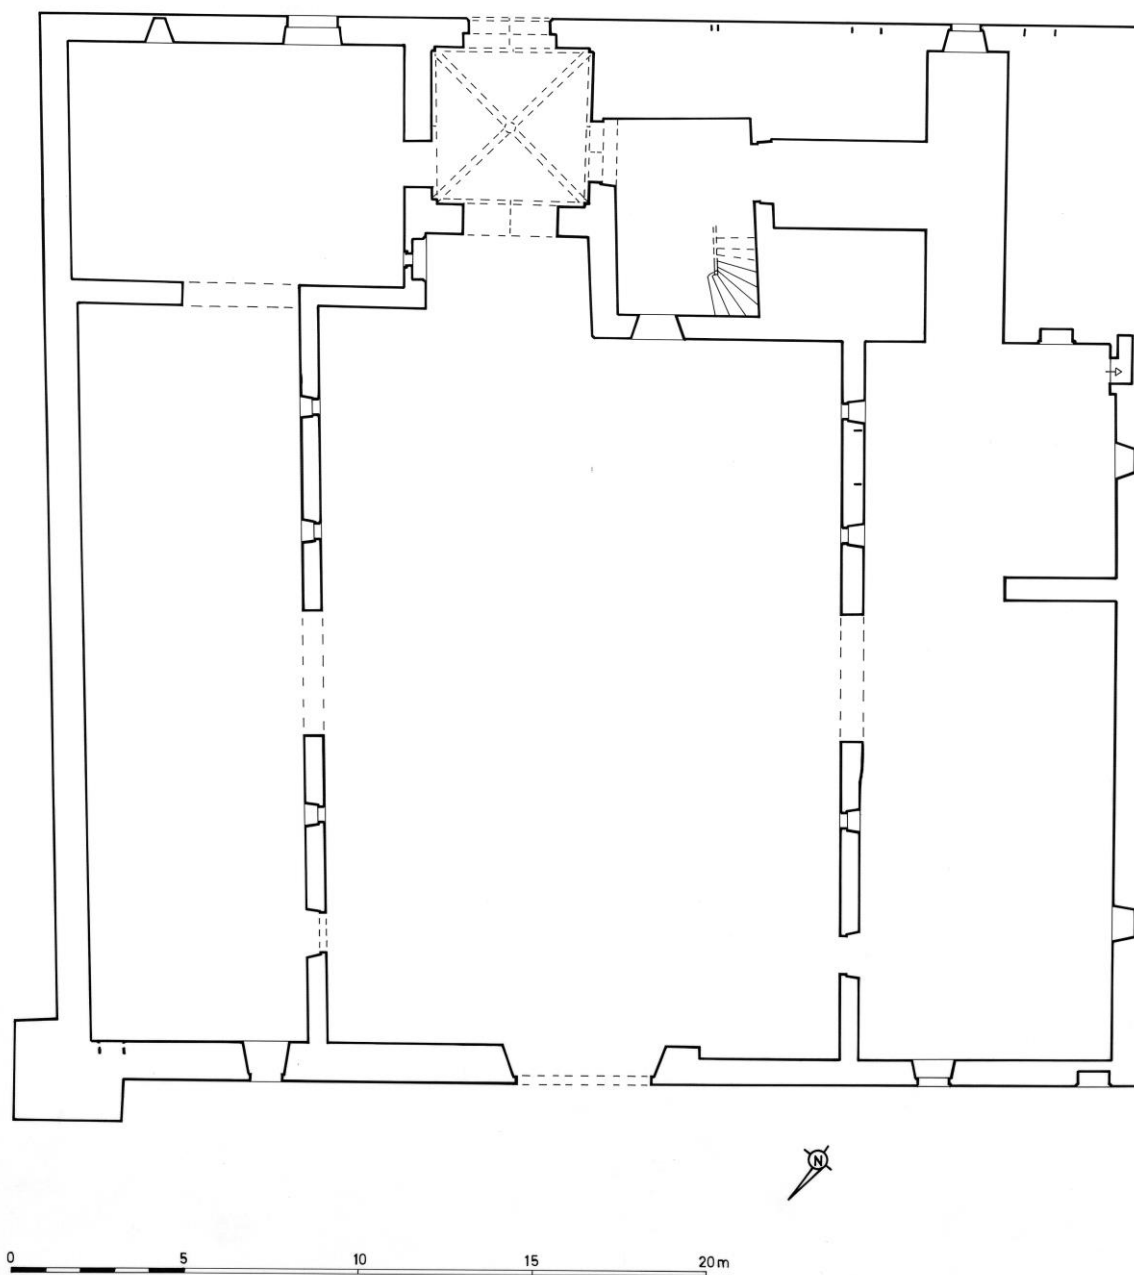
Relevé du plan du château par Patrick Roques (1997) : rez-de-chaussée.
